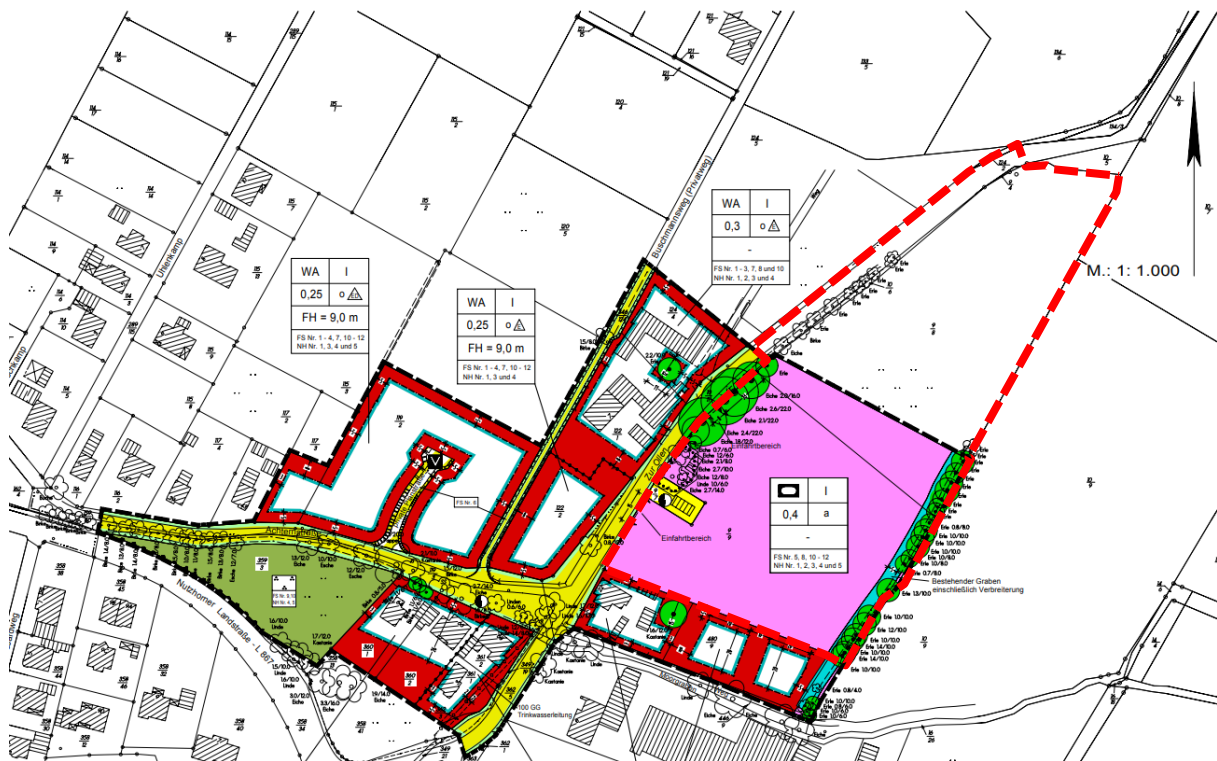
Planzeichnung B-Plan Nr. 215 "Sporthalle Altengraben" mit Geltungsbereich des B-Plans Nr. 277
